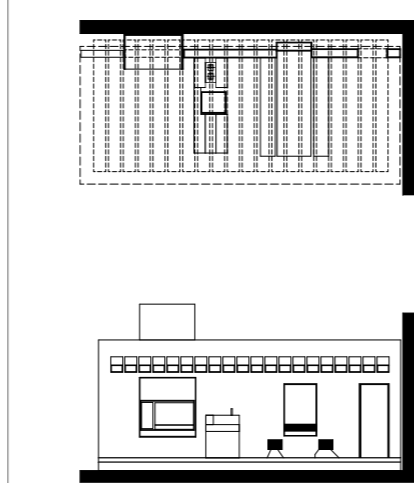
Planta y sección Quincho Casa del Gallo, Rafael Iglesia
